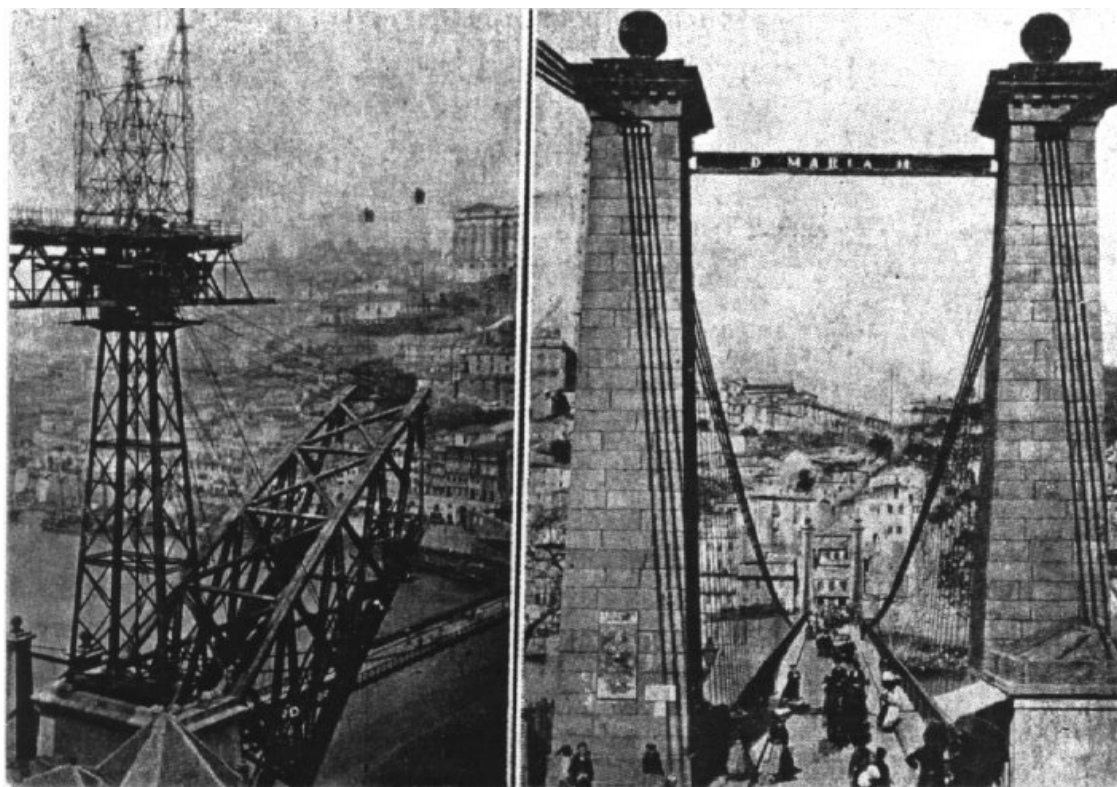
A demolida Ponte Pênsil ao lado da Ponte Luís I, no início de construção.
